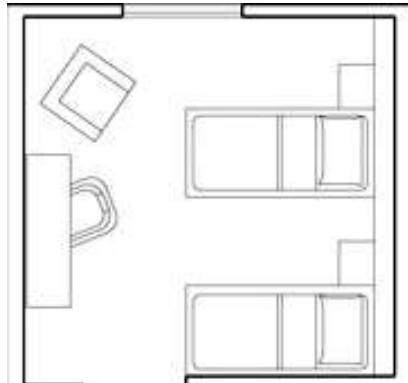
Esempio schema planimetrico camera da letto⁵²
